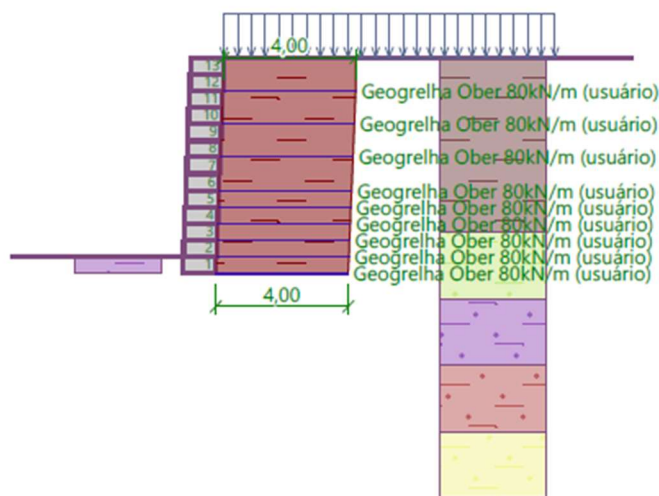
Perfil da seção de 6,5 metros do Muro 1
